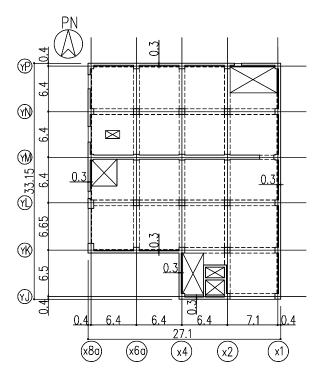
地上1階平面図 (G.L.+0.3) (単位:m)
